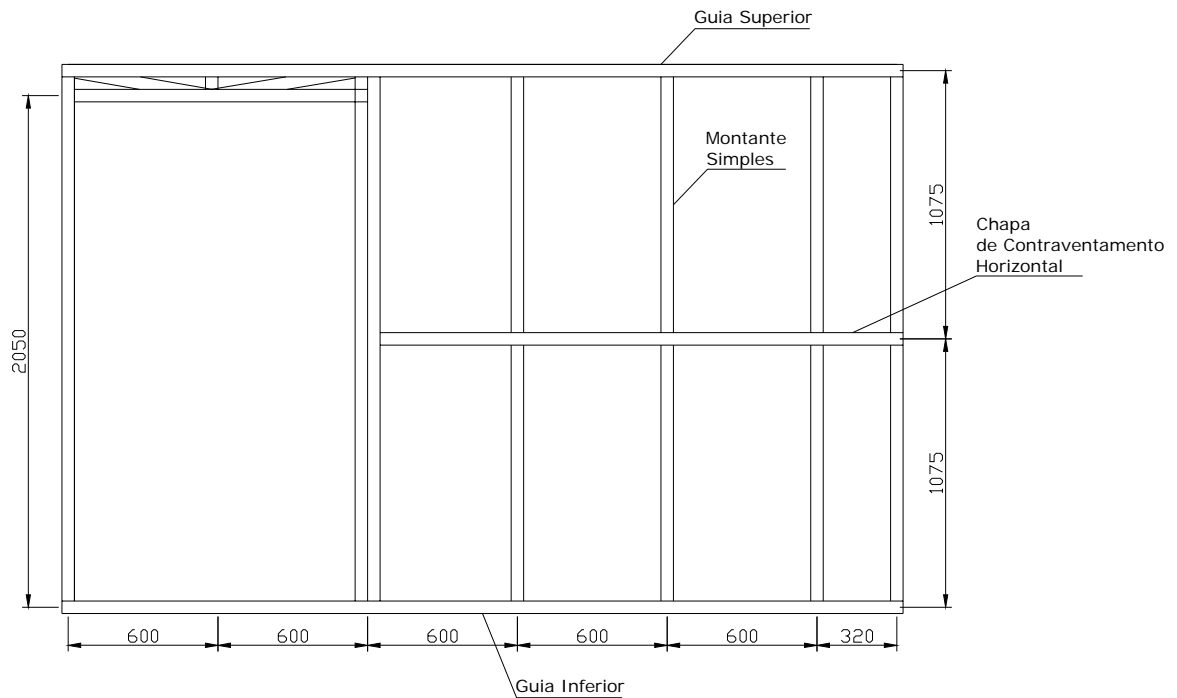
Parede estrutural “Steel-Frame” com abertura de porta
